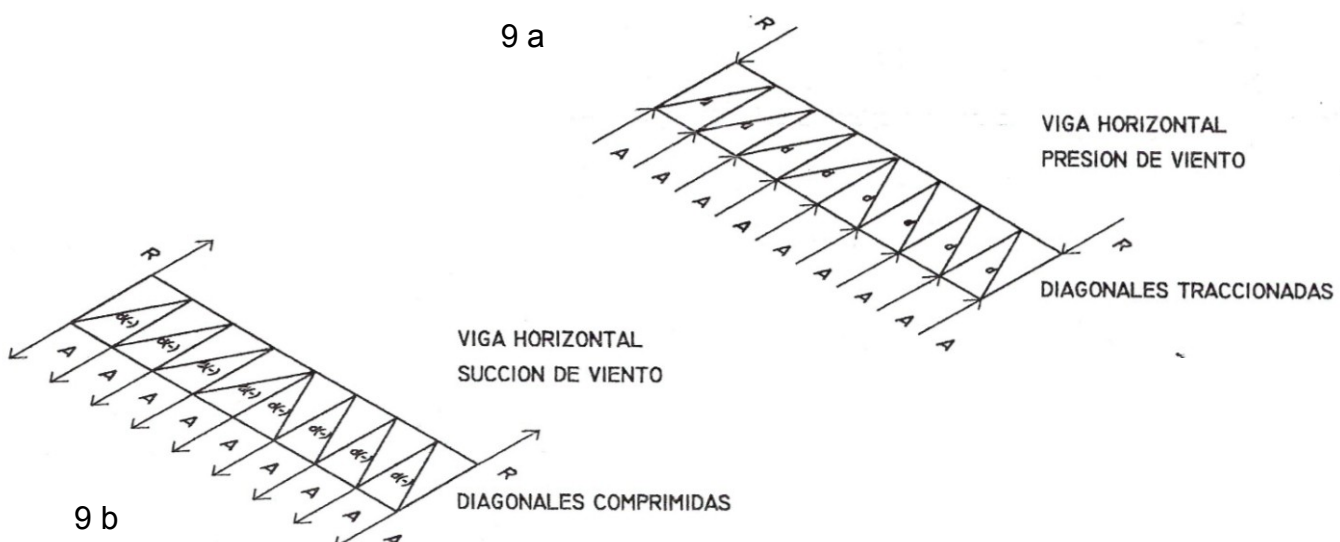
Estructura de cubierta. Viga horizontal para cargas de viento.
